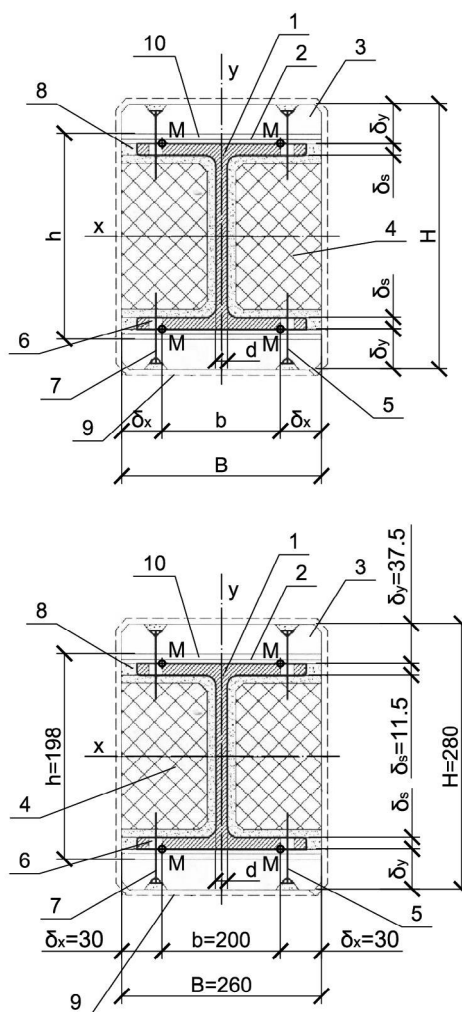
Расчетное поперечное сечение огнезащищённой стальной колонны:
